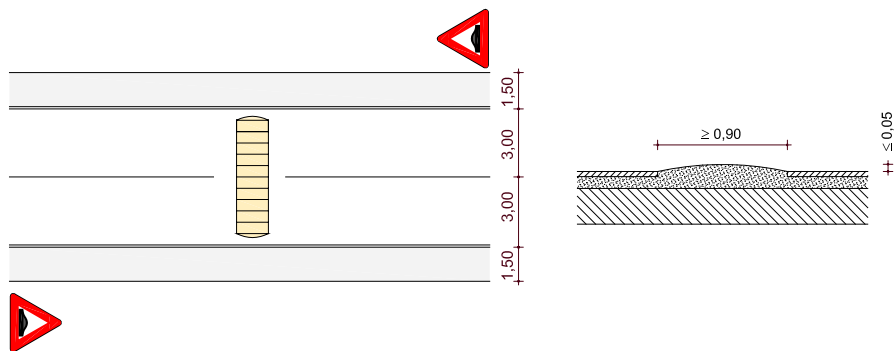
TRATTO STRADALE PAVIMENTATO RIALZATO
